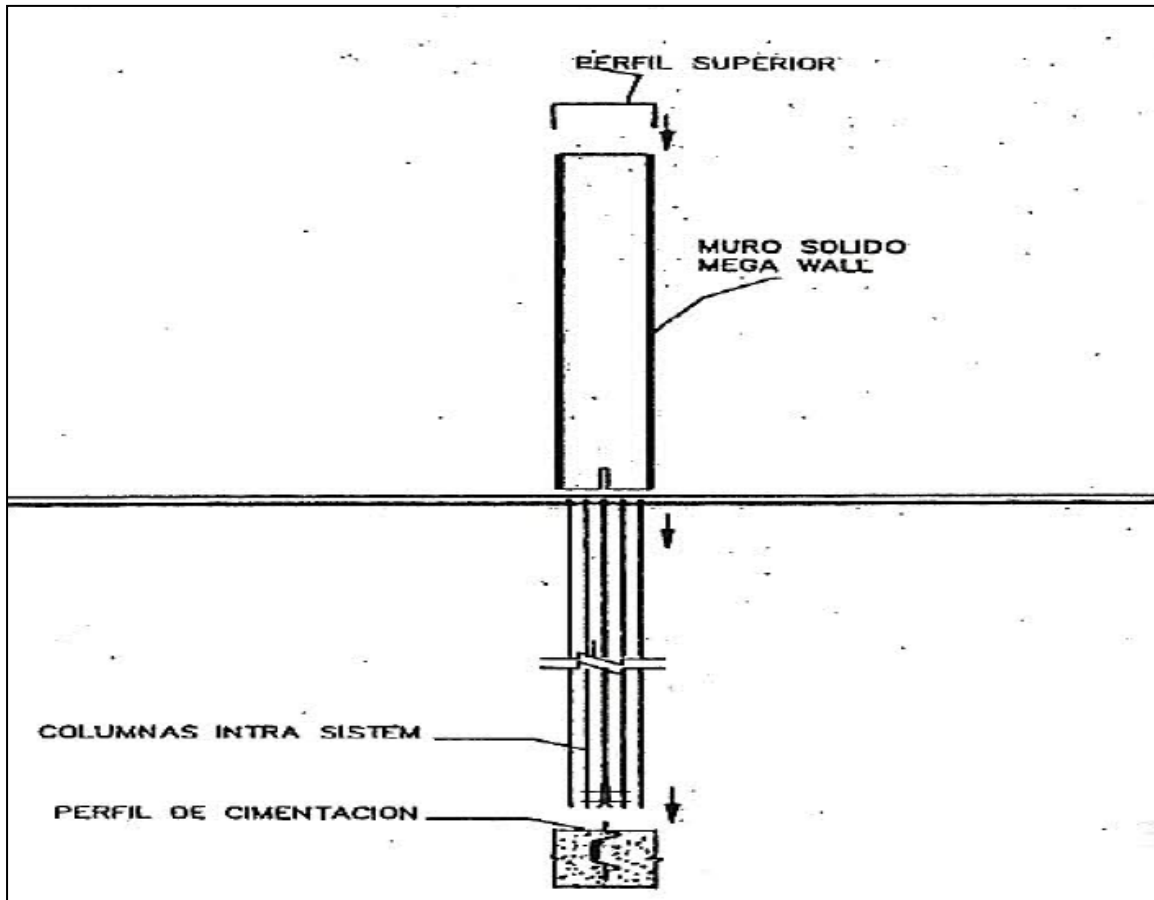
Detalle de montaje columna Intrasistem en perfil de cimentación
